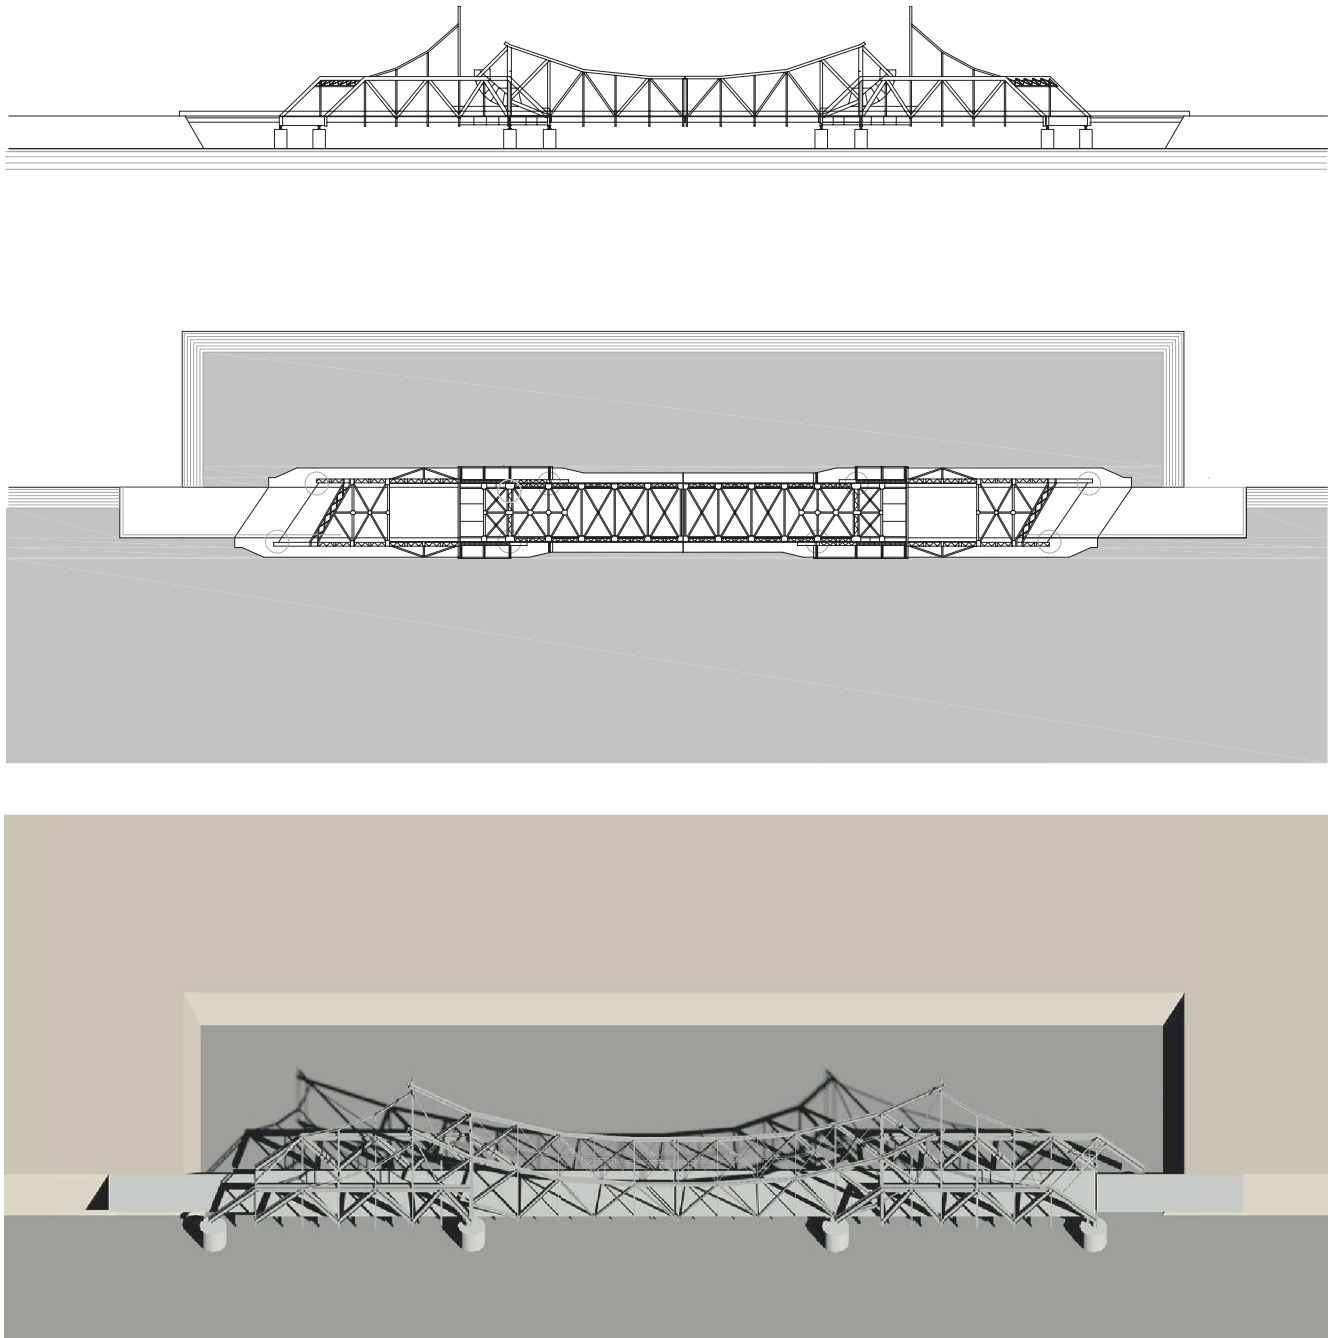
Planta, alzado y perspectiva de la propuesta de reubicación y puesta en valor del puente de Alfonso XIII. Dibujo: Óscar Gil Sánchez-Carrasco.
